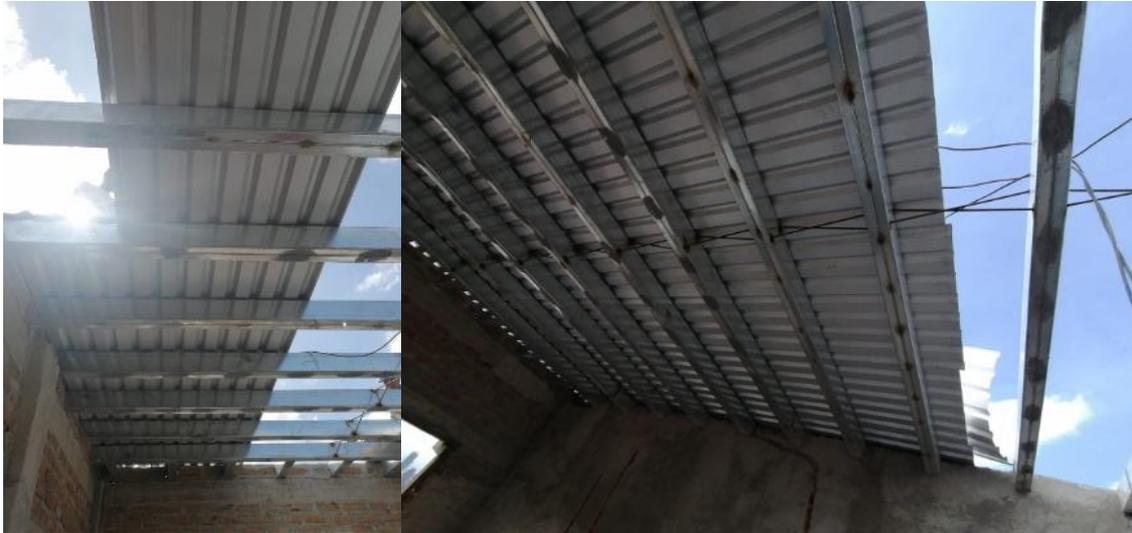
Visualización de plano en planta de canaletas dobles de 4"
